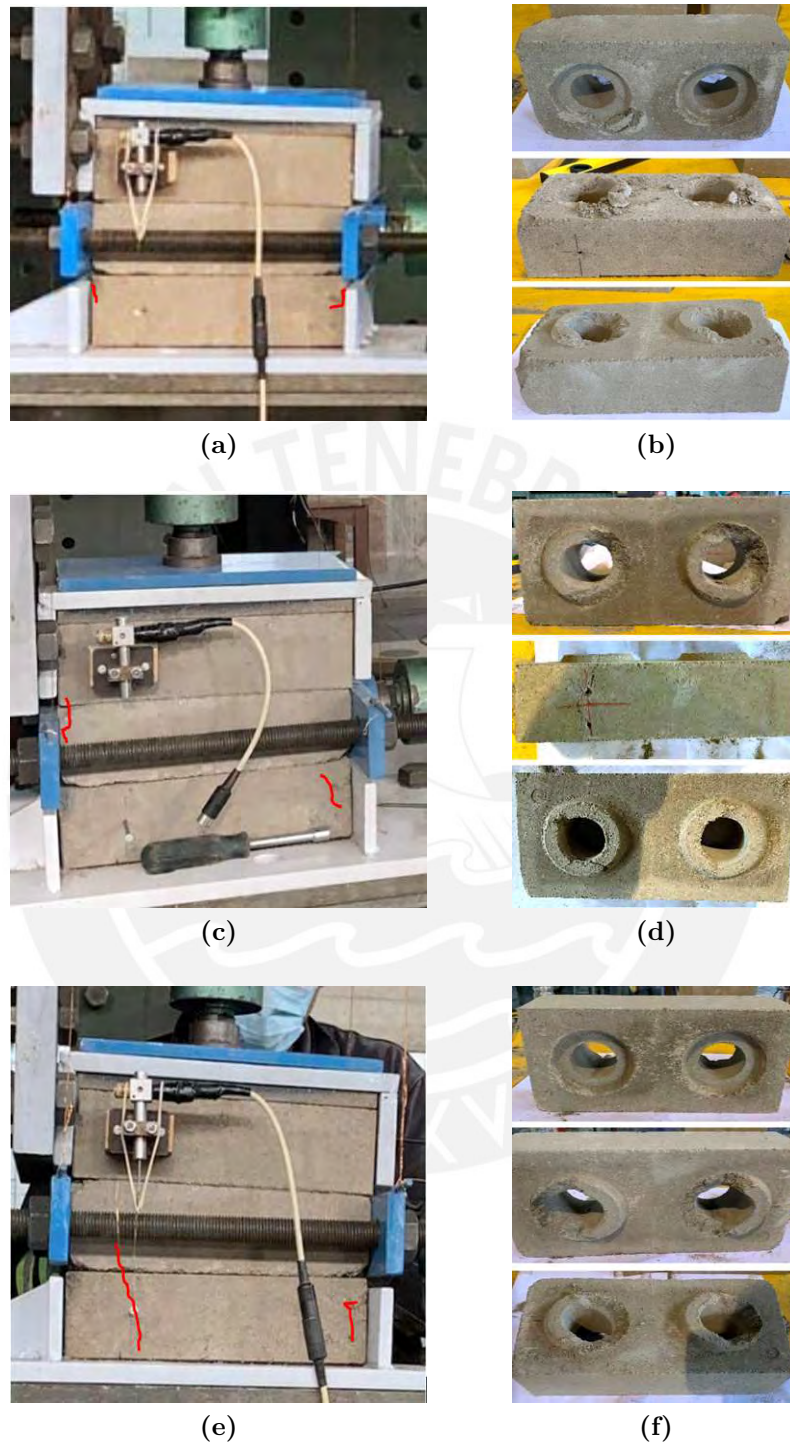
Patrones de falla en pila PCL bajo un esfuerzo de precompresión de 0.02 MPa: (a-c-e) grietas en la vista frontal de la pila y (b-d-f) fallas generadas en las unidades.
